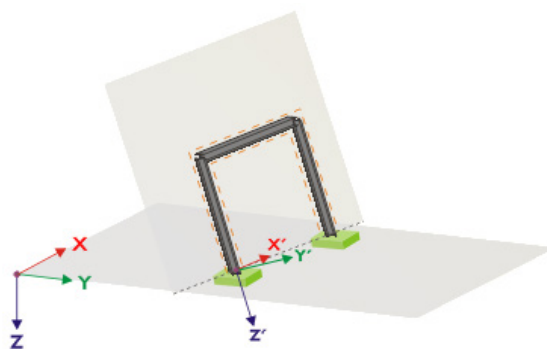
Sistema de coordenadas auxiliar para apoyos en nudos - conjunto de barras en plano inclinado
